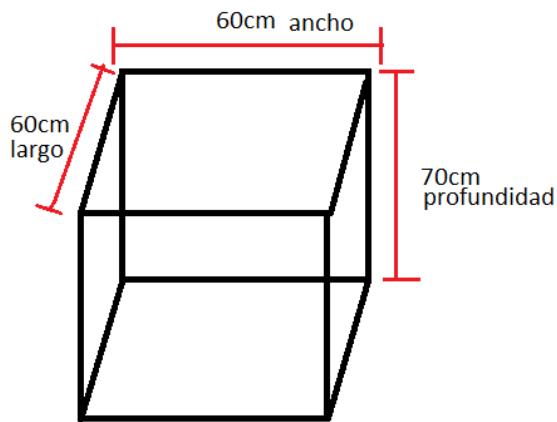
Dimensiones de la “cajuela” que hay que cavar.
